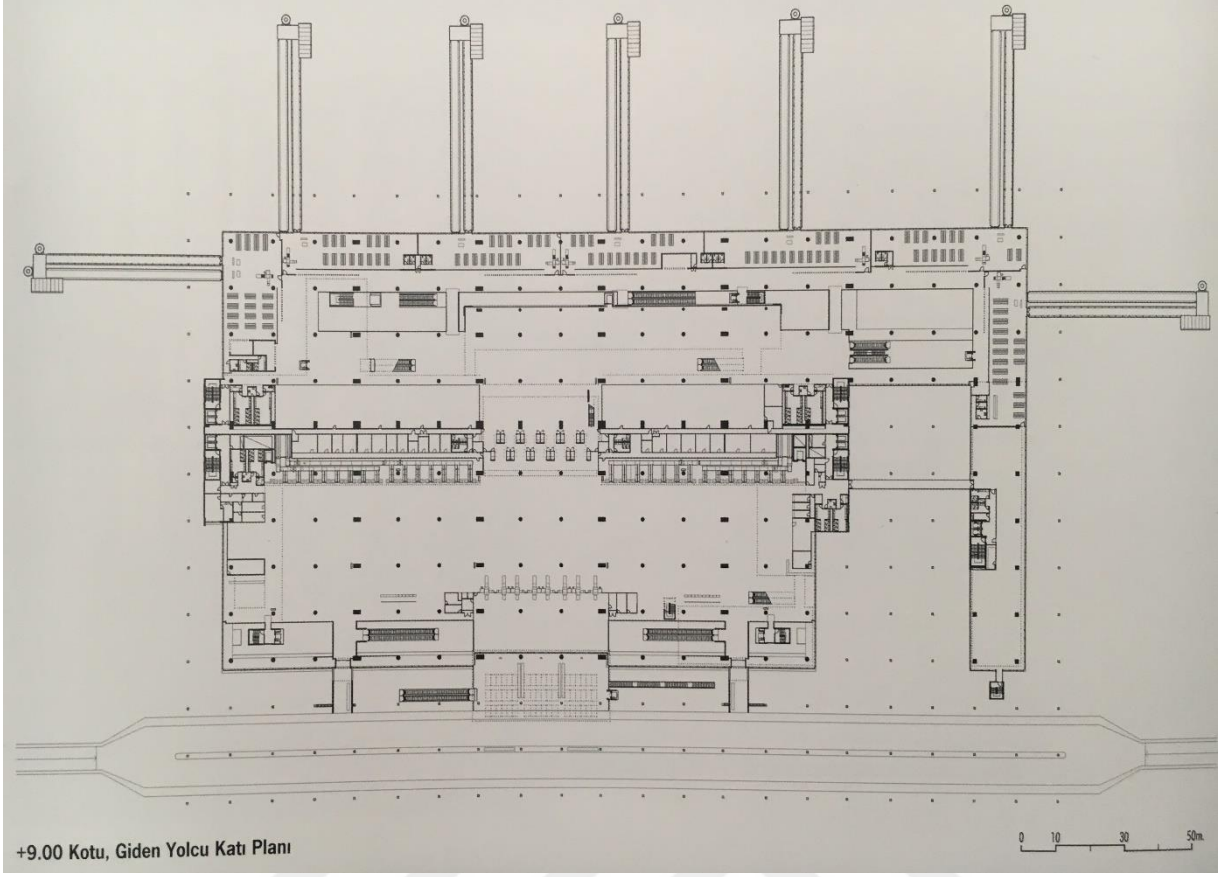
Terminal binası vaziyet planı (Yem Yayın, 2013:19).
